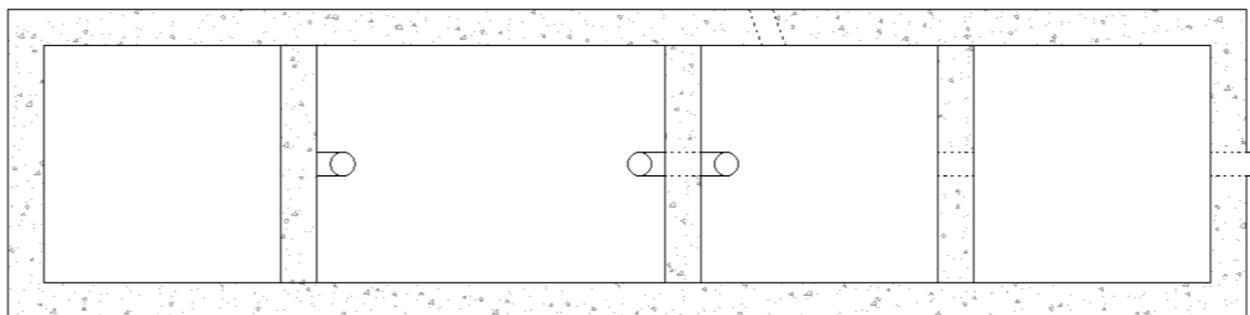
Trampa de grasa Italcol planta 2 vista planta
